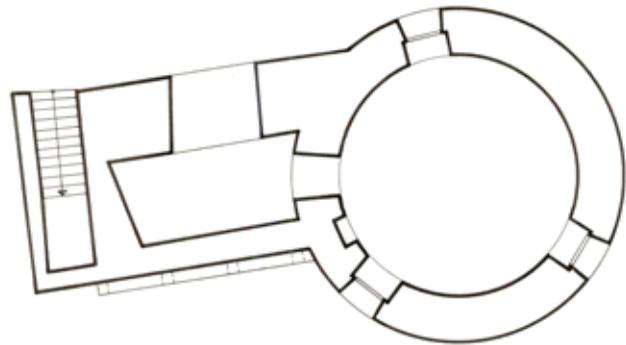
Grundriss des Untergeschosses in St. Peter am Kammersberg N° 45, M 1:200. BDA Planarchiv Wien.
